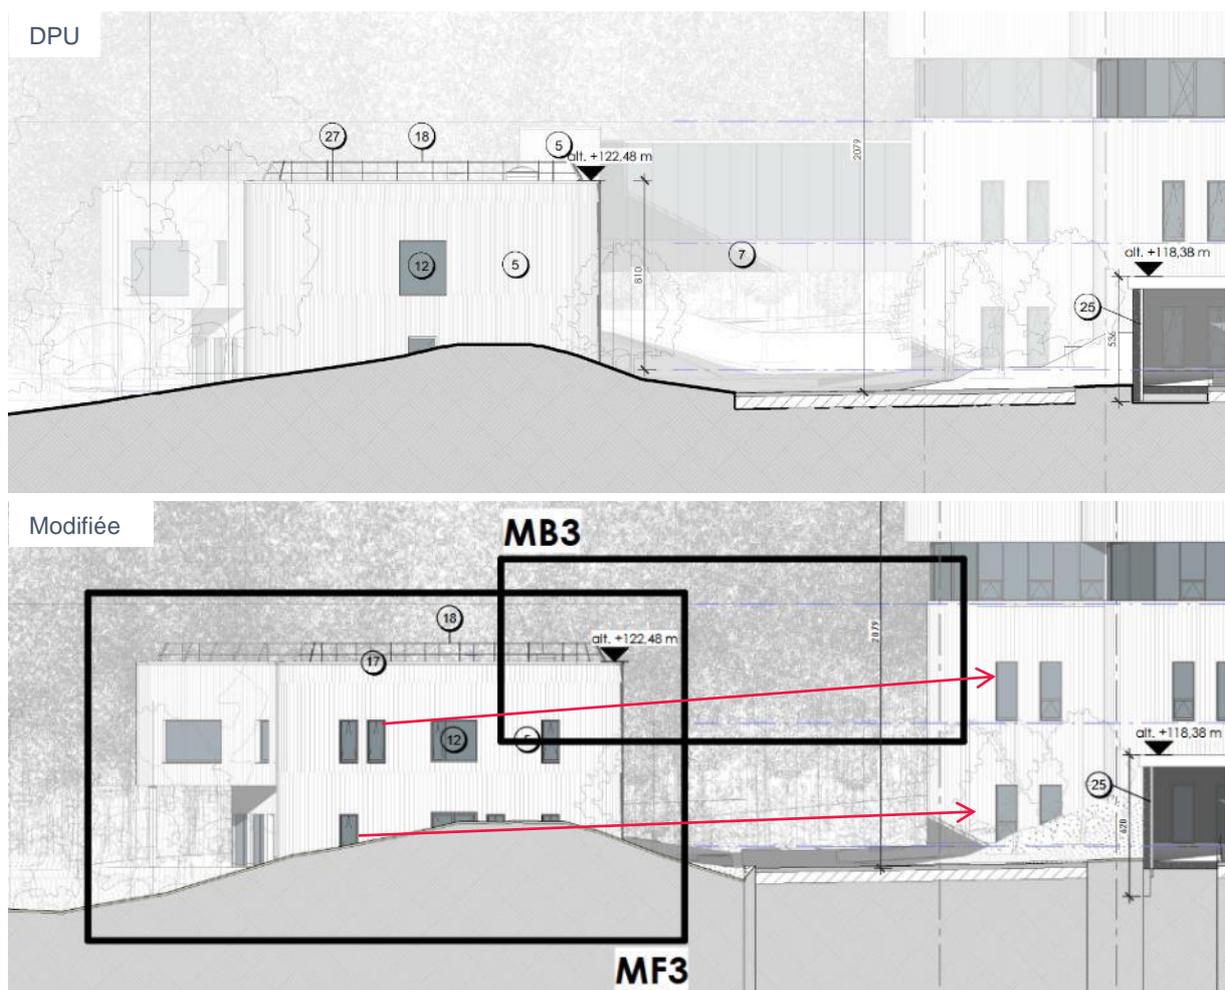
Modifications de la façade du pavillon de psychiatrie (source : ASSAR)
